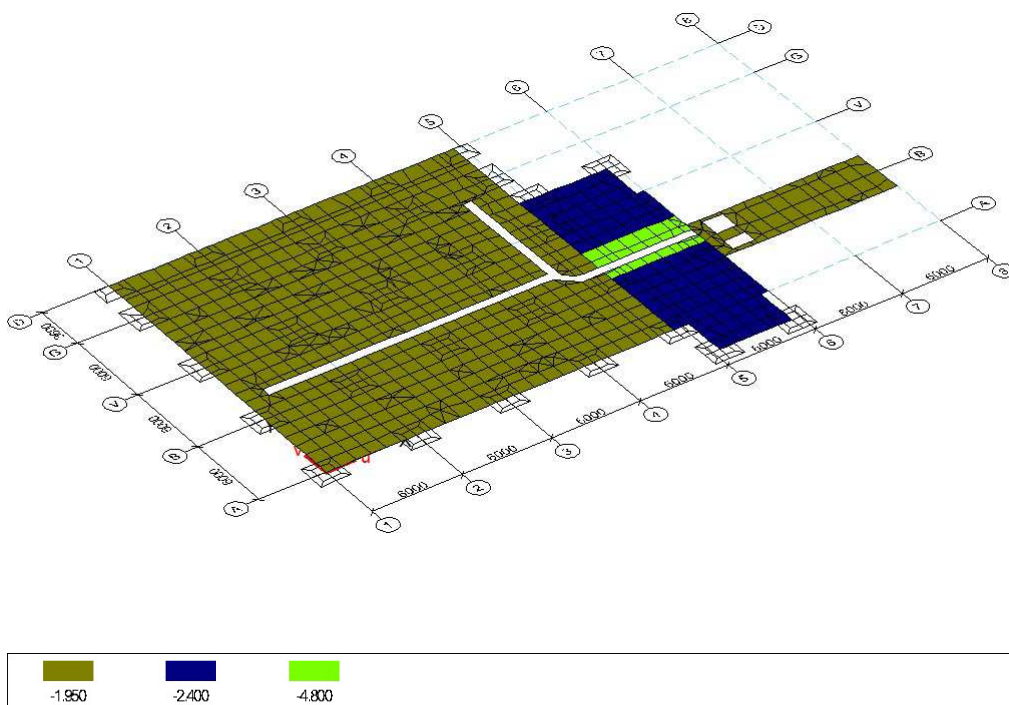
Эксплуатационная нагрузка на перекрытия на отм. 0,000
